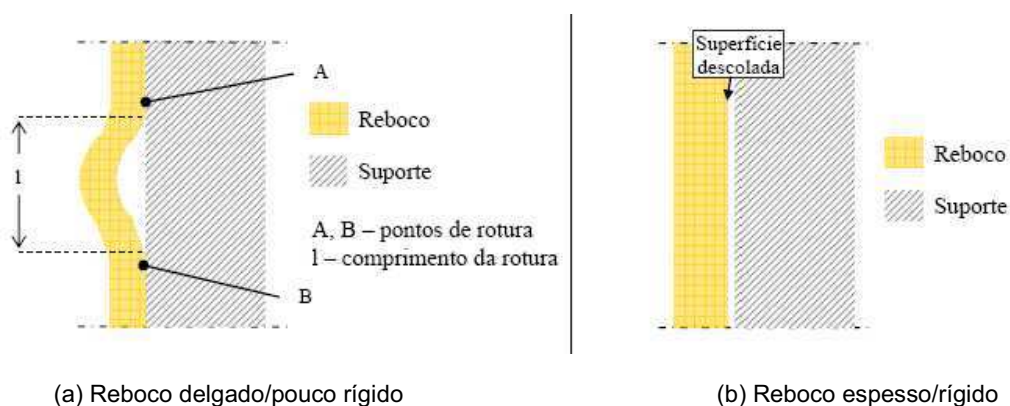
Esquema de rotura do reboco por dilatação do reboco [26]
